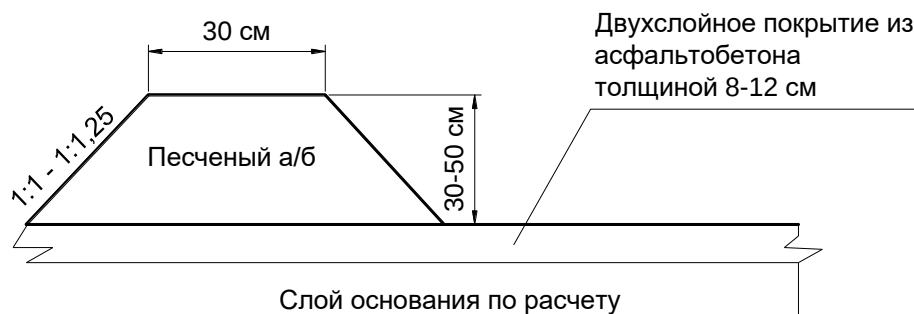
Обваловка открытой площадки для хранения сыпучих бестарных химических и комбинированных ПГМ
